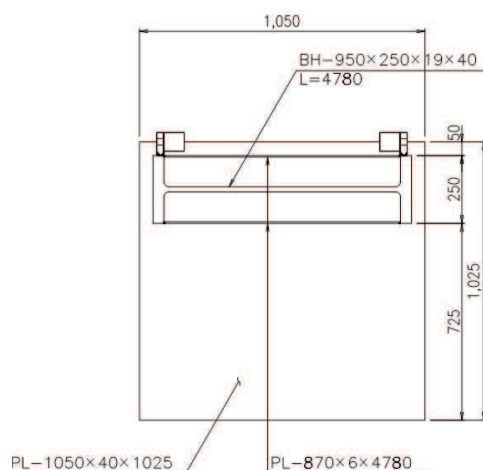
防護梁最下段の詳細図 (単位: mm)
